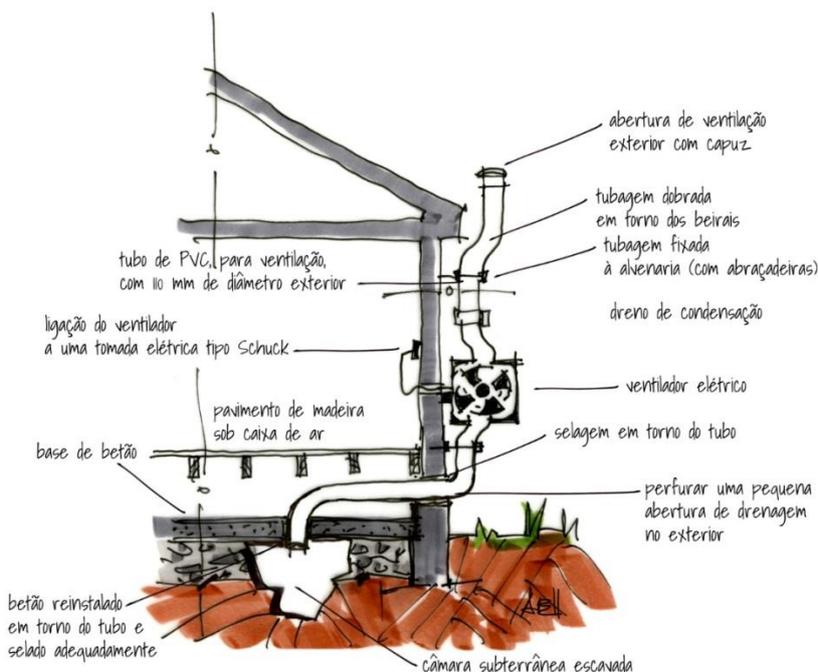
Exemplo de sistema de despressurização do terreno debaixo da laje térrea, com condutas e ventilador localizados no exterior
